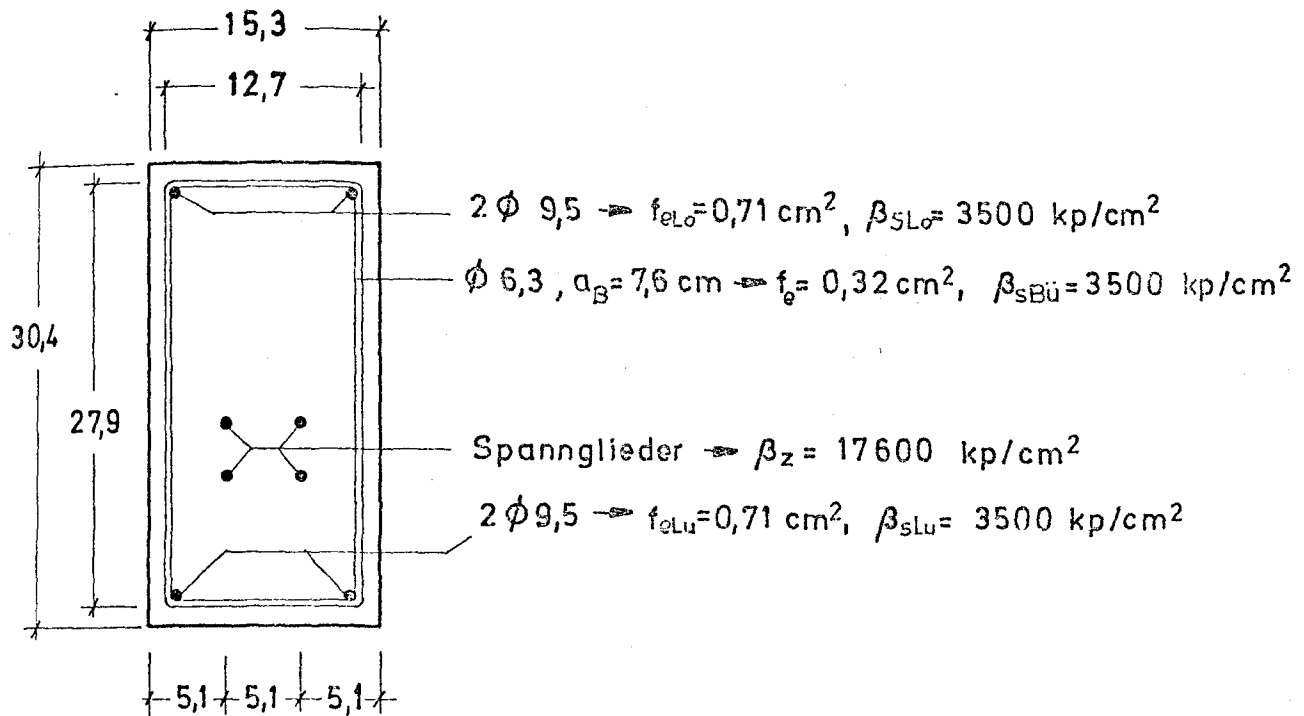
Bewehrung des Versuchsbalkens T 8 nach
